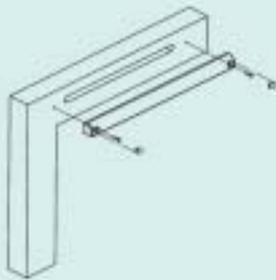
exemple de fixation d'un auvent sur fenêtre
